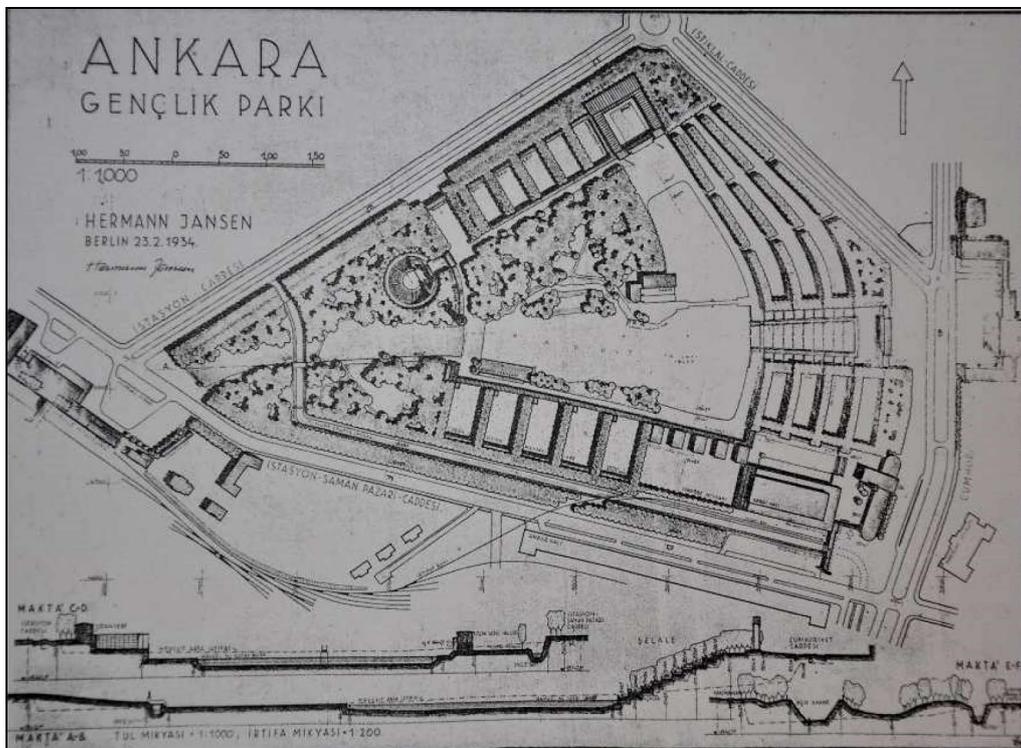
Hermann Jansen, Gesamtbebauungsplan Ankara, Teilbebauungsplan Jugendpark, Lageplan 1934.
